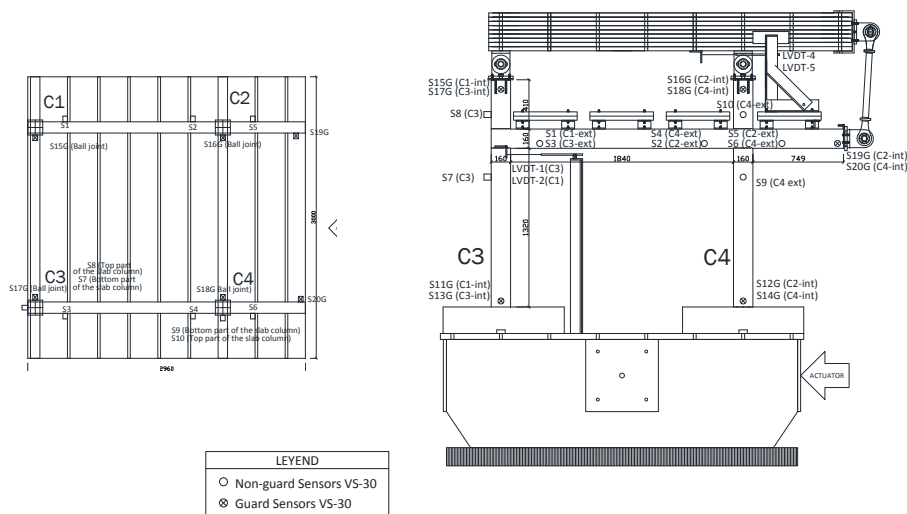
Posición de los sensores de EA colocados en el espécimen. Izqda.: vista en alzado; Dcha.: vista en planta.
